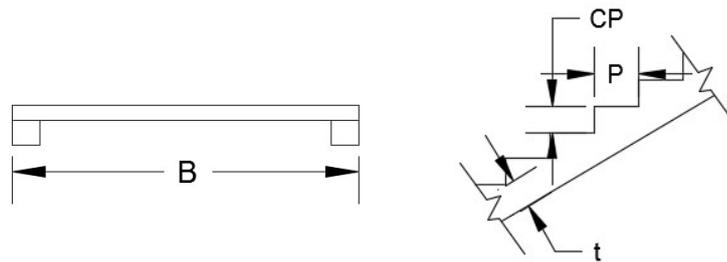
Modelo de escalera apoyada transversalmente
